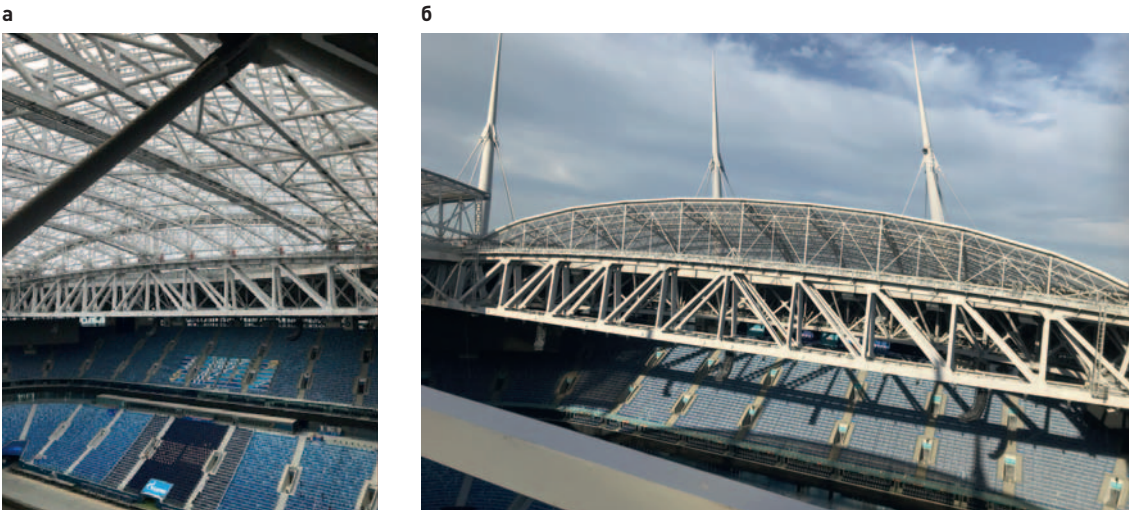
Ездовая ферма для опирания трансформируемой части покрытия «Газпром Арена»
